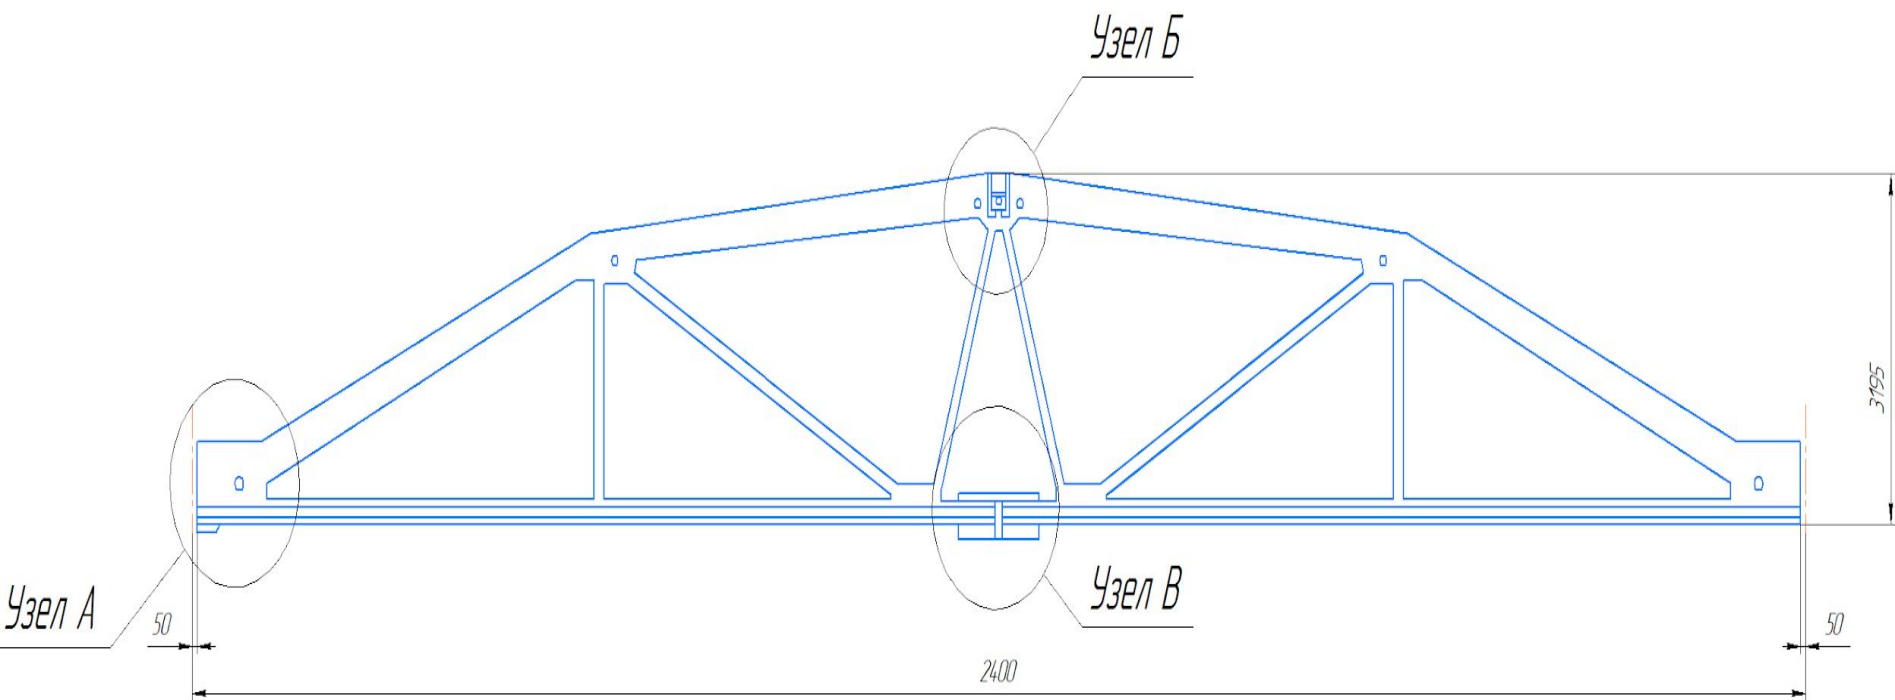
Чертёж сегментной фермы ФАСБ-24-1
